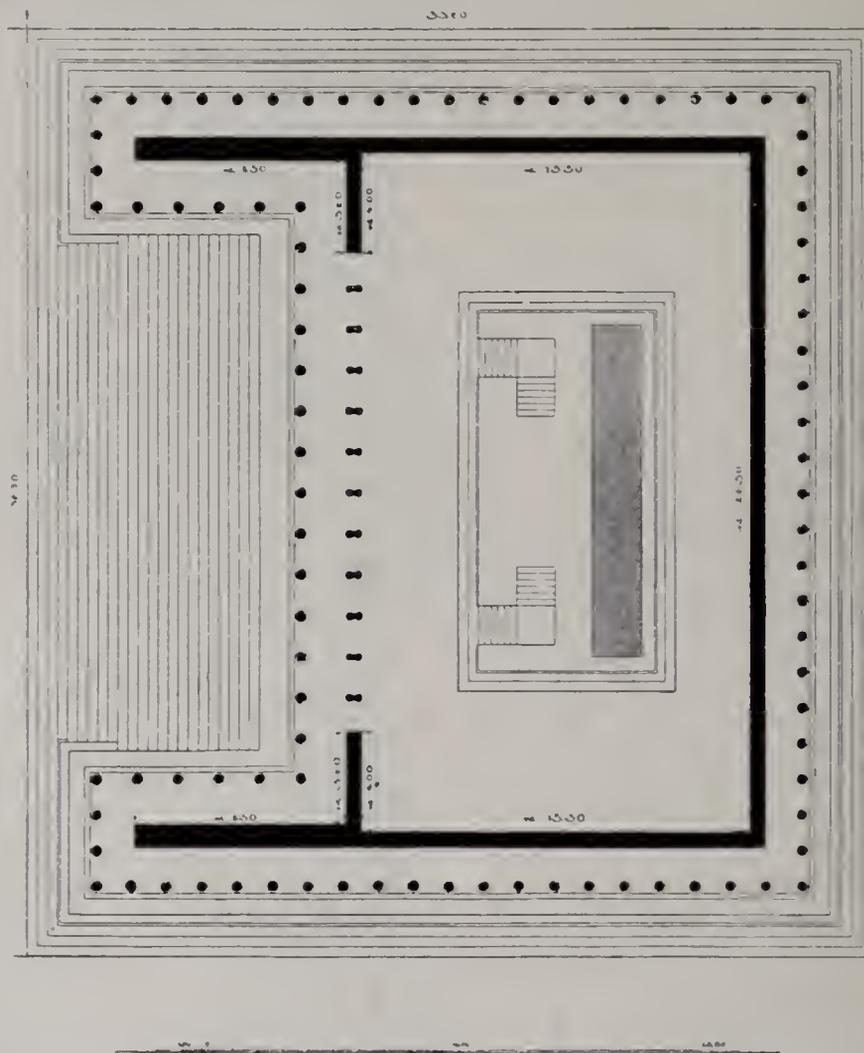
Prachtaltar zu Pergamon. Grundriß. (Nach Schrader.)
